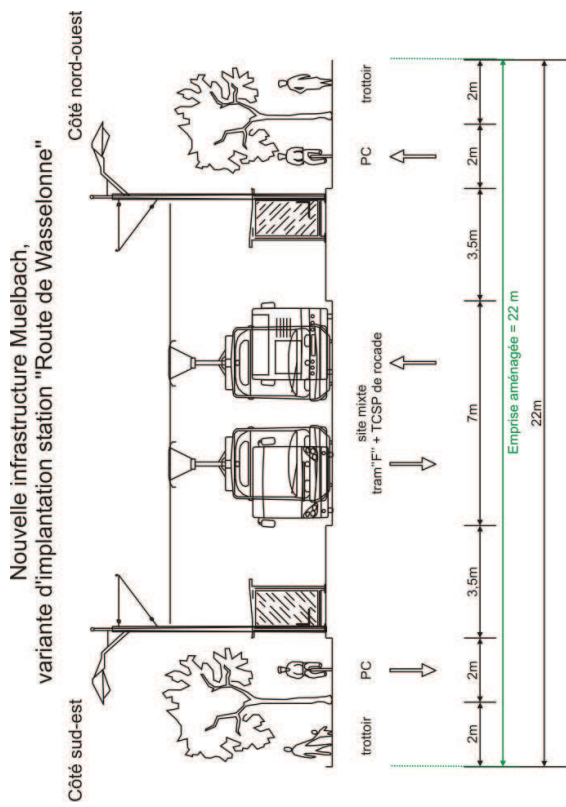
Variante d'implantation de la station "Route de Wasselonne" (nouvelle liaison entre route de Wasselonne et avenue Leclerc)
